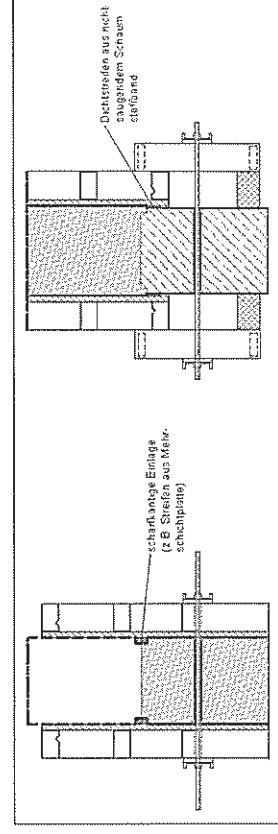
Flächenbündige Arbeitsfuge; links: erster Betonierabschnitt; rechts: zweiter Betonierabschnitt
